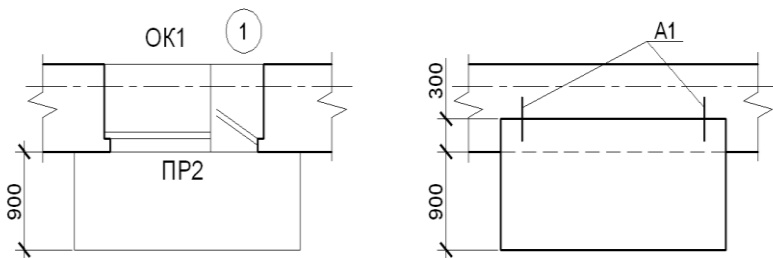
Изображение балкона на плане этажа и плане перекрытия
